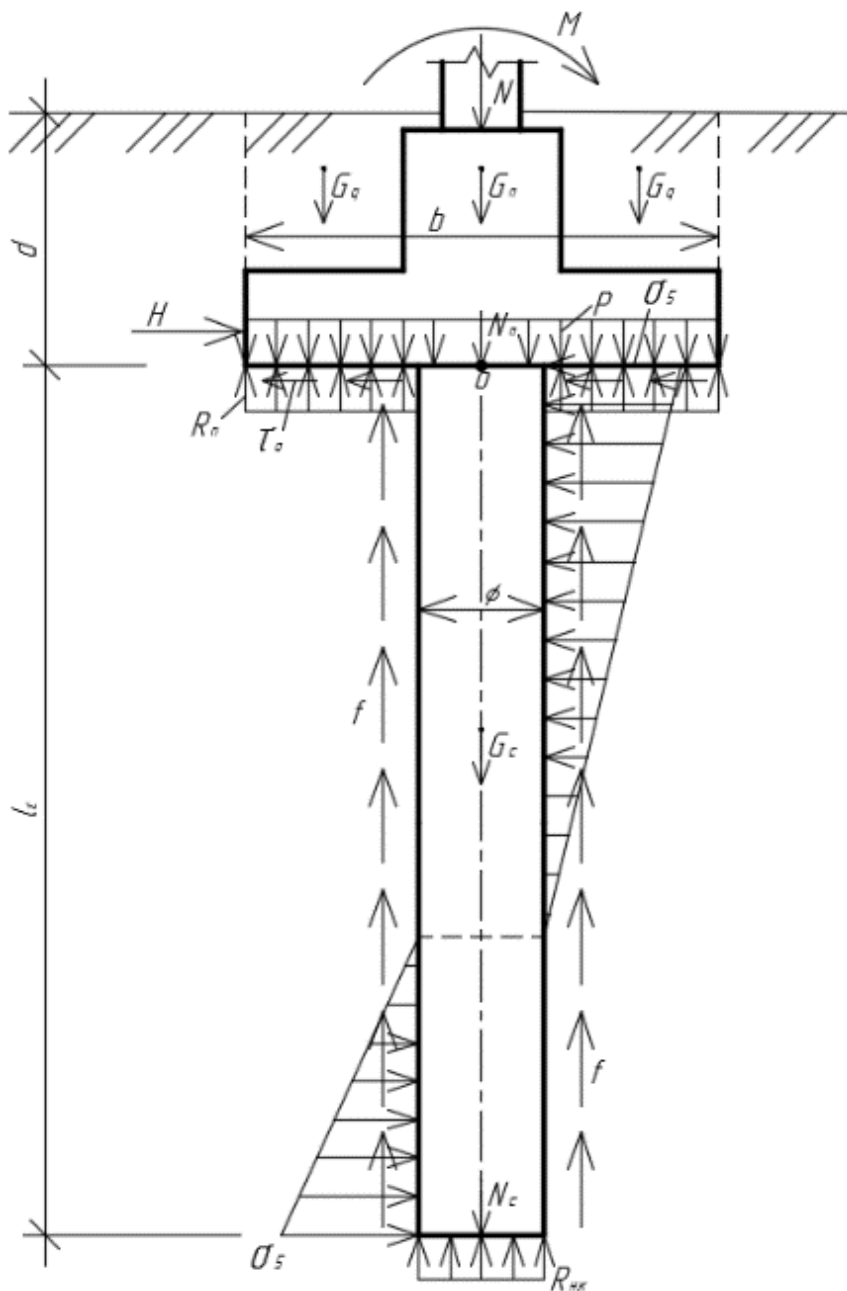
Силовая схема односвайно-плитного фундамента
